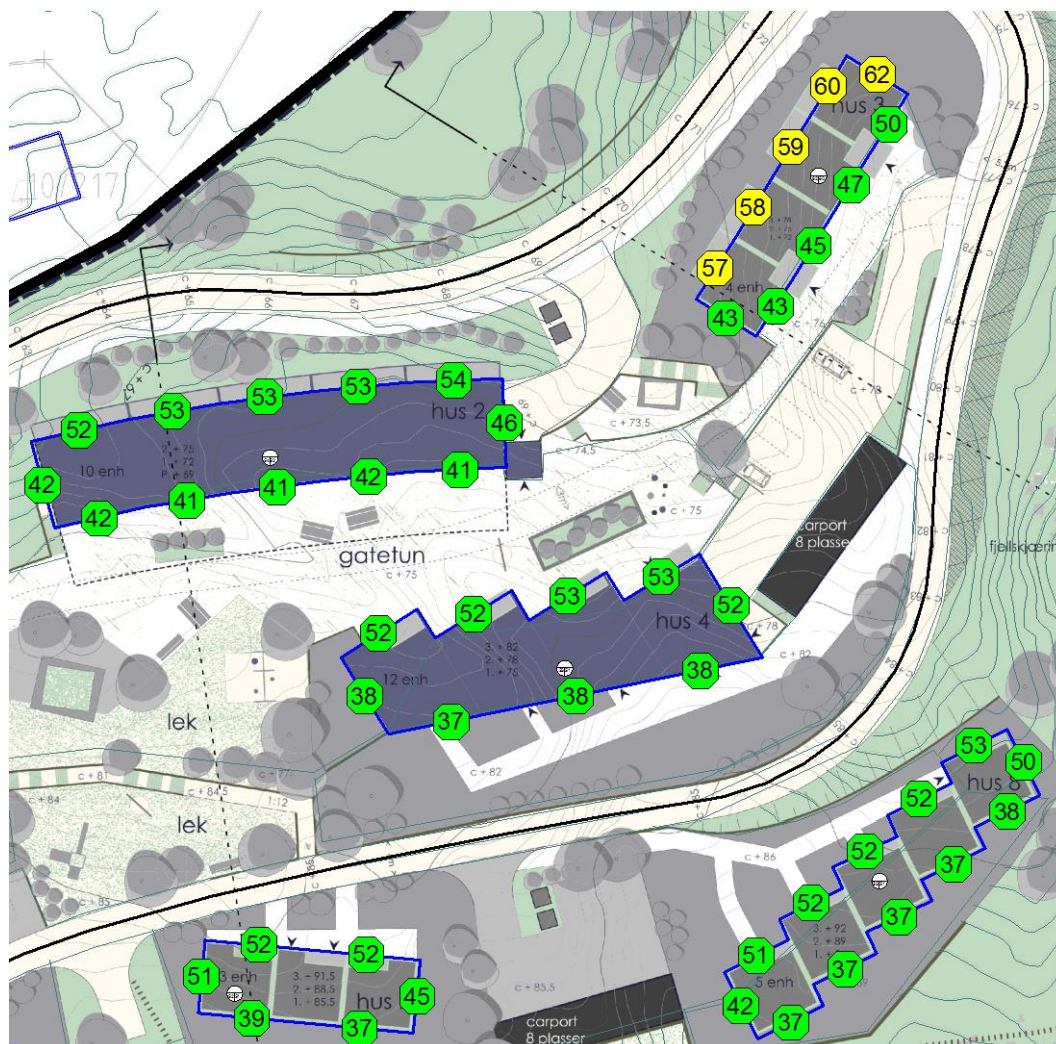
Utsnitt av illustrasjonsplan (ABO Plan og Arkitektur, 13.11.2015)
